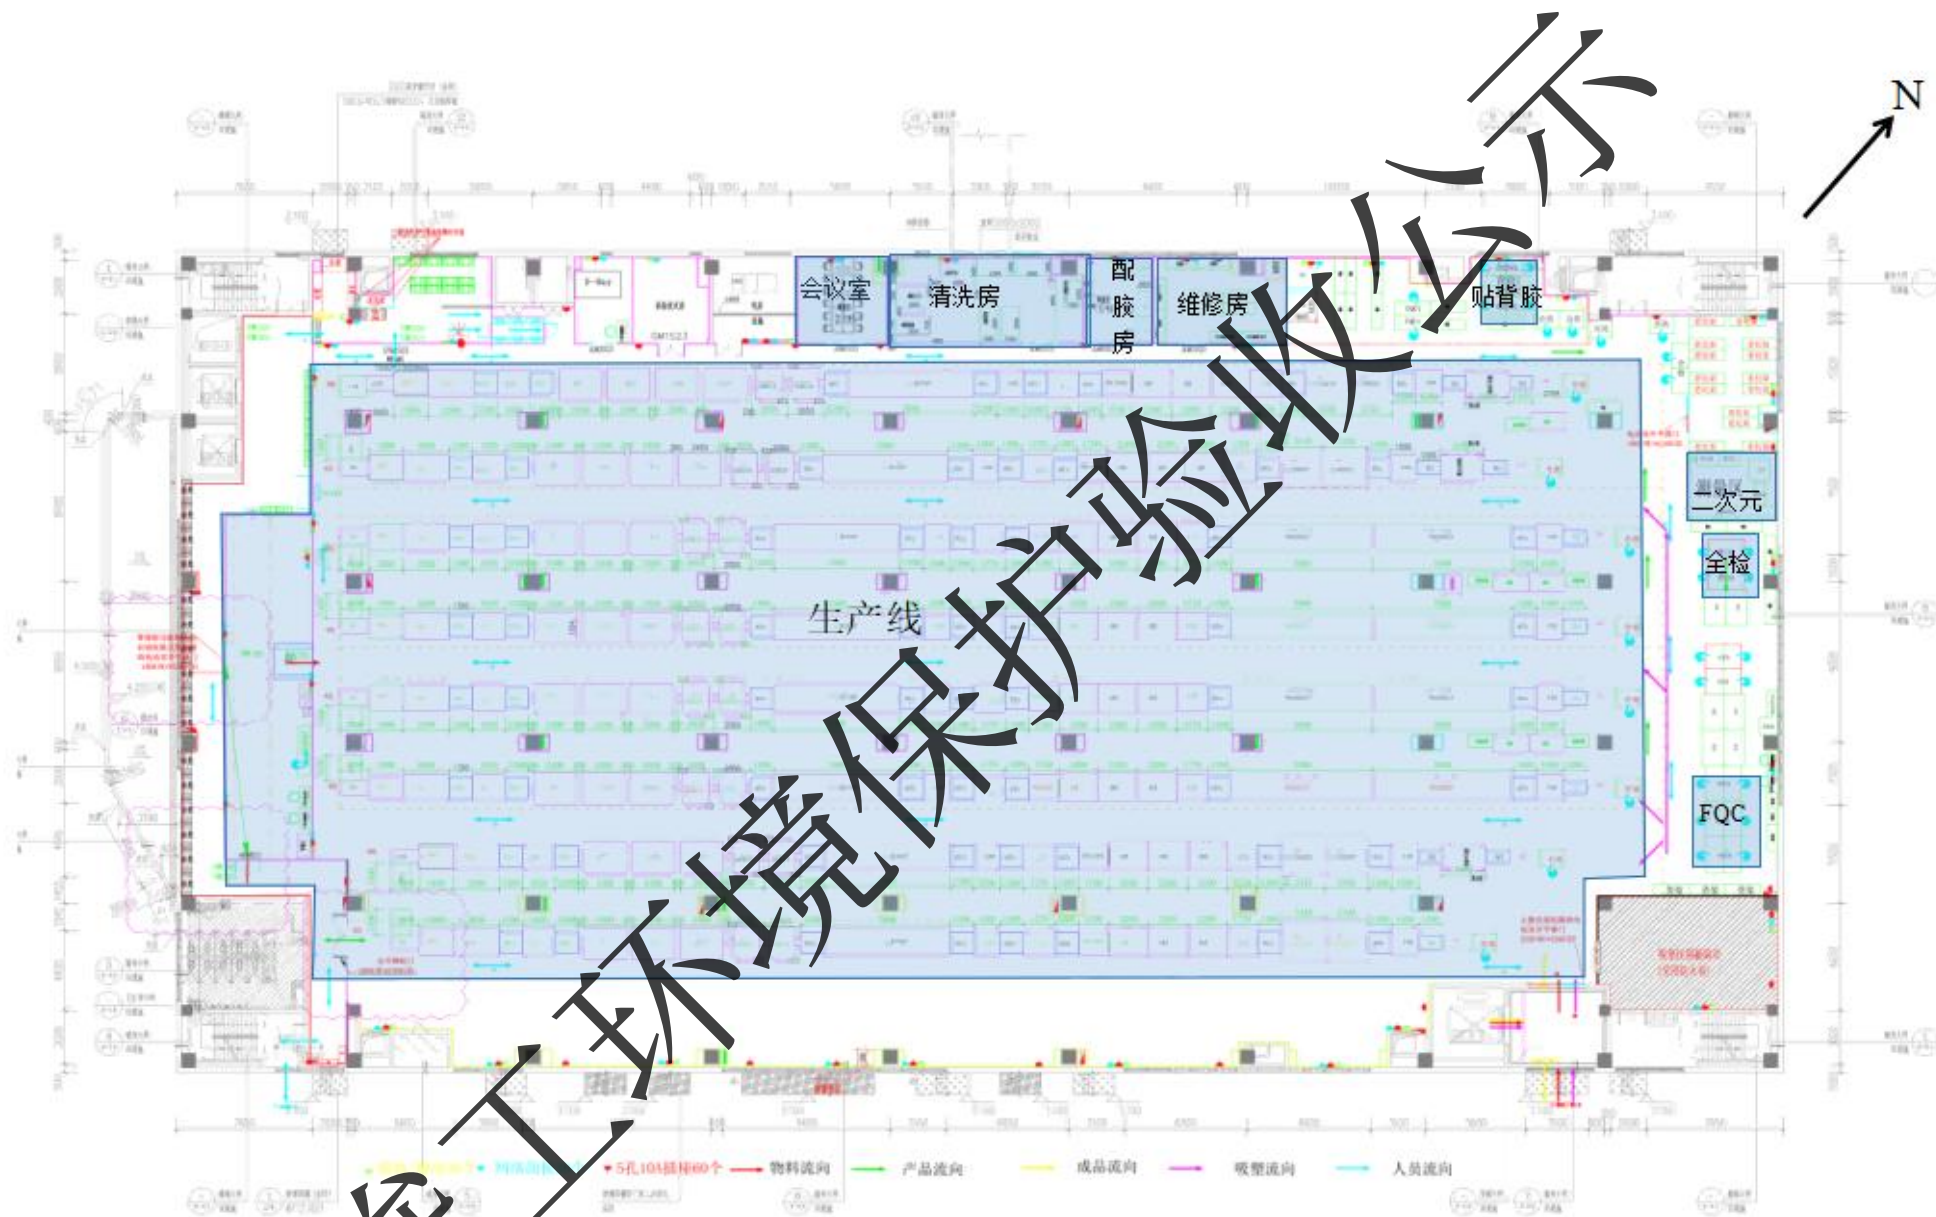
(2) 平面布置图 (生产车间: 2#厂房 2F)
